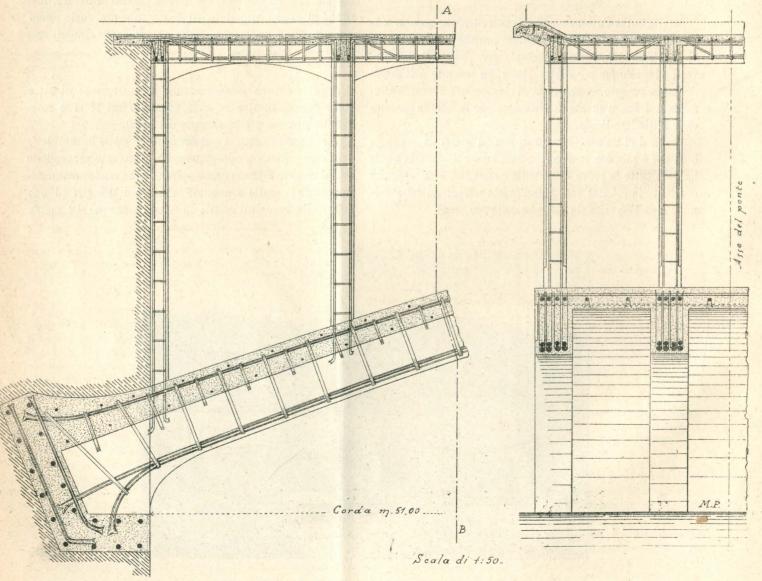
Parte di sezione longitudinale e metà della sezione trasversale, secondo AB.
